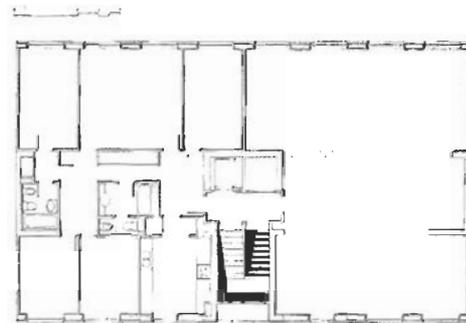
Planta de las viviendas en la Villa Olímpica
